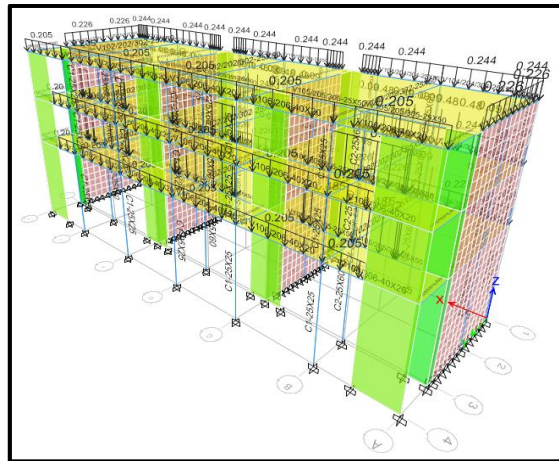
Bloque 2 cargas muertas lineales por tabiquería y parapetos
